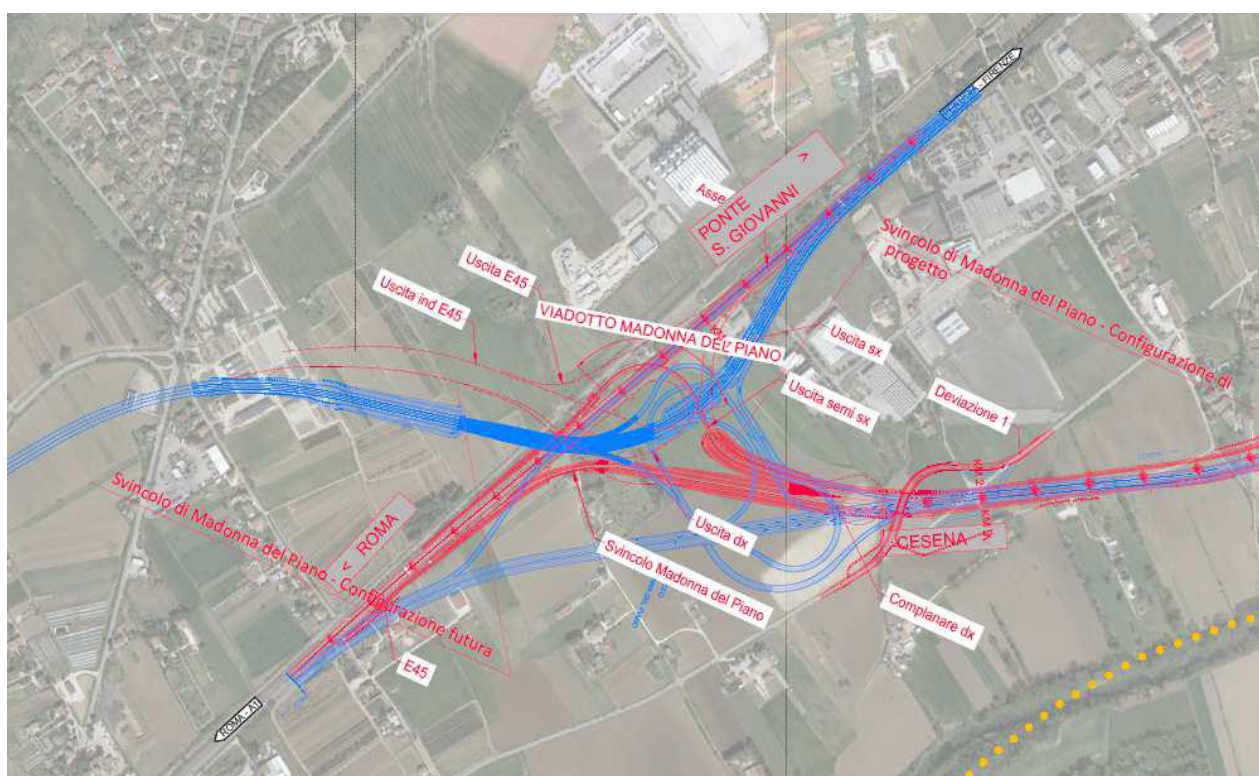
Plano-profilo di confronto Svincolo Madonna del Piano (in rosso il progetto definitivo nella configurazione parziale attuale)
